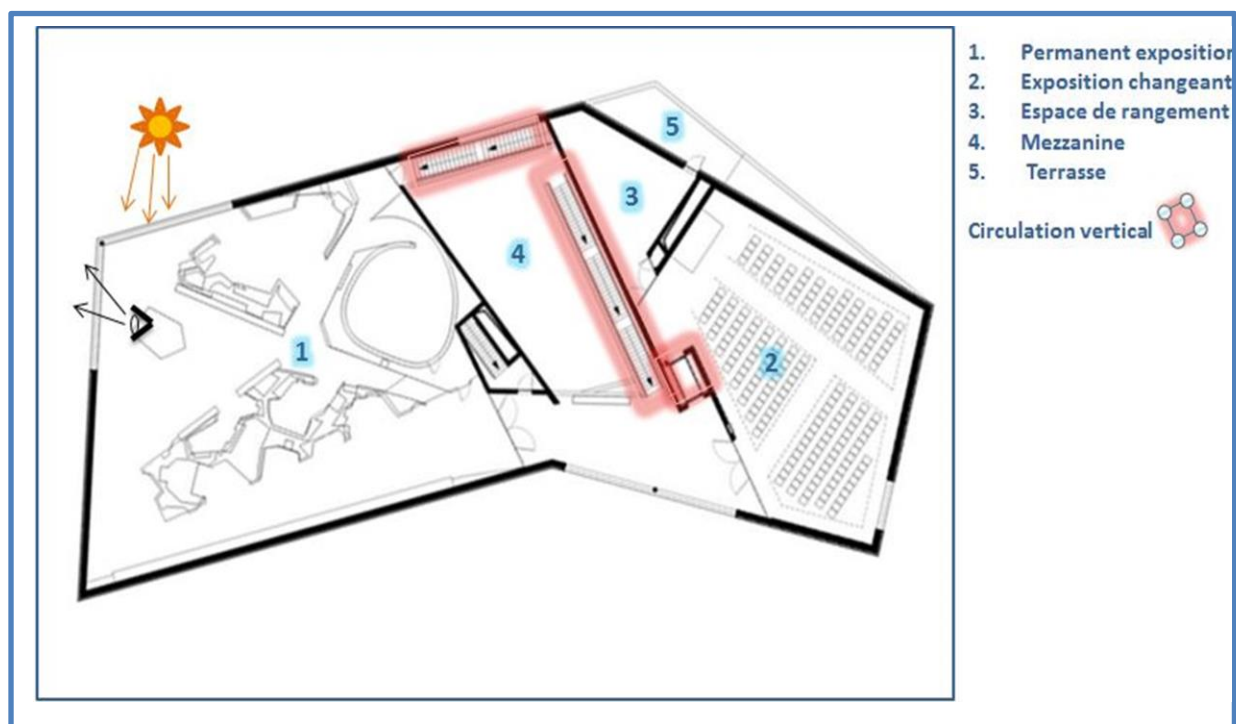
PLAN R+2 DU CENTRE .SOURCE ARCHDAILY
